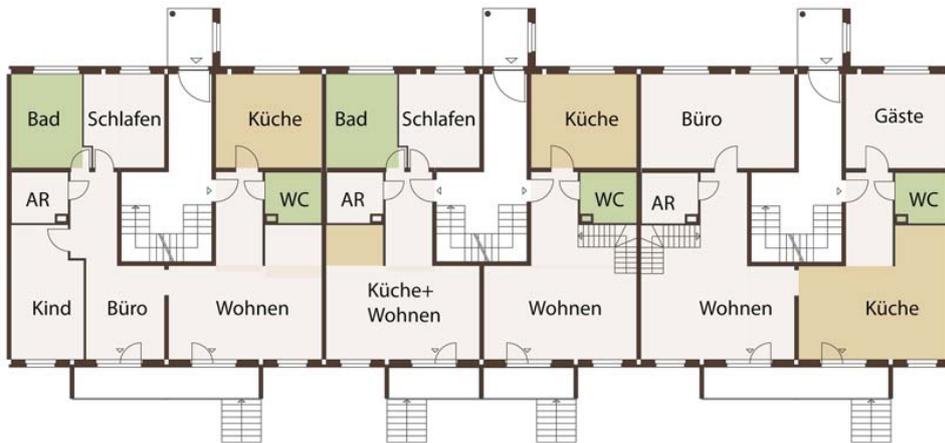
Grundrissvorschlag Reihenhäuser
